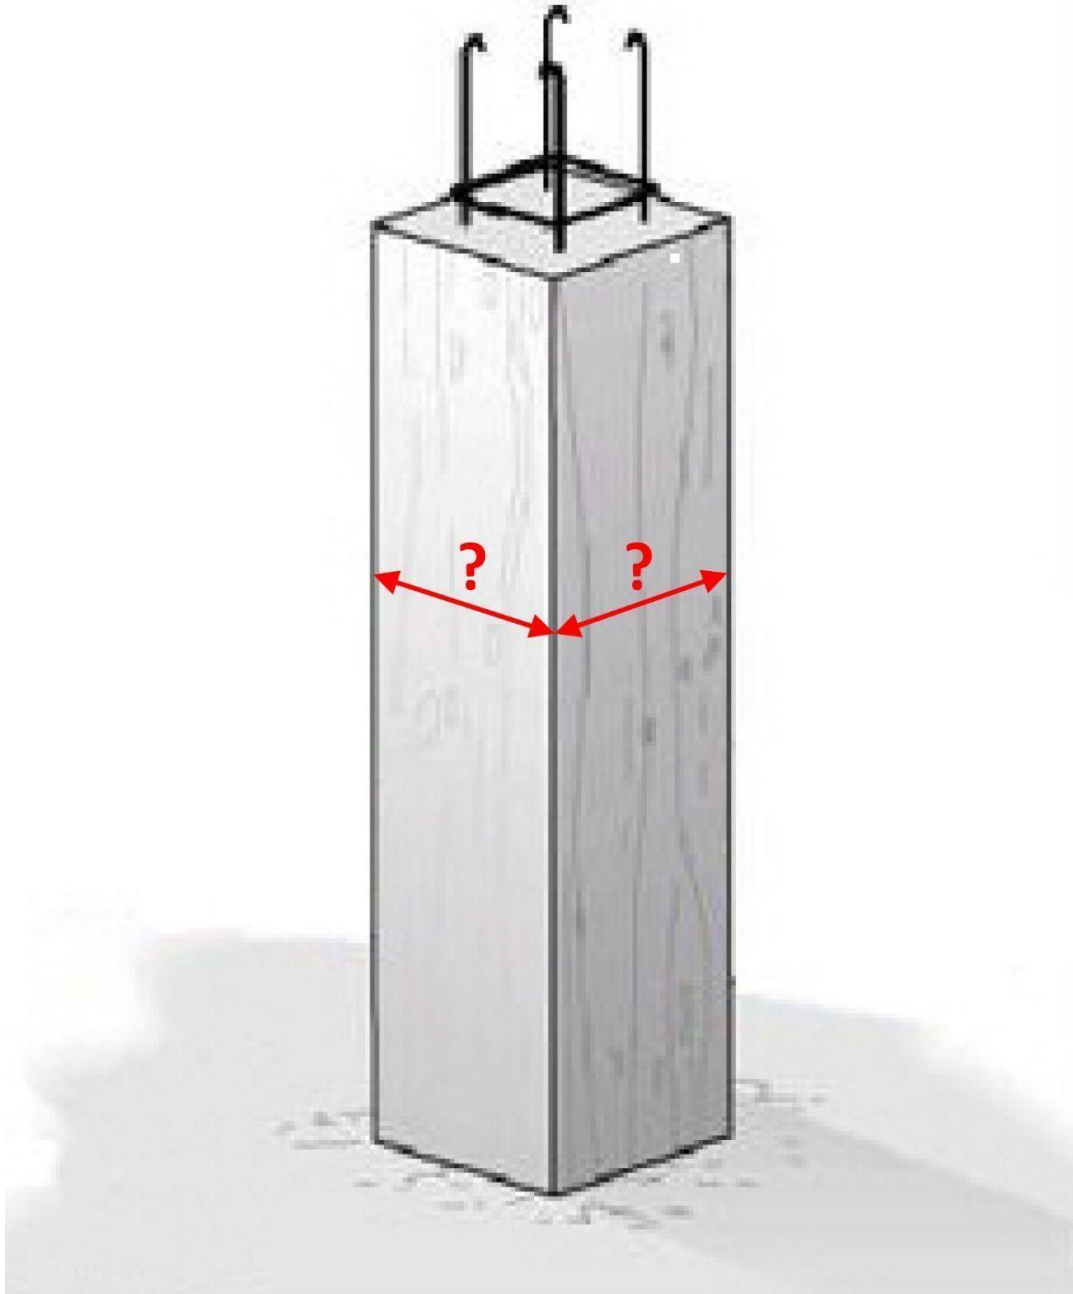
Pilar armado sin dimensionar. Fuente: estructurando
